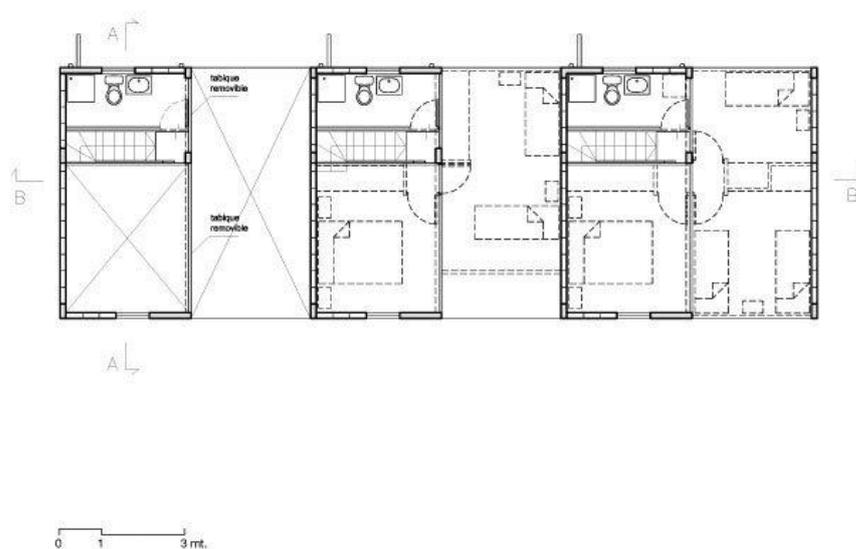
, 24 e 25 – Quinta Monroy – Elemental – Iquique – Chile. Plantas que ilustram o projeto e sugerem possíveis arrajos espaciais - Fonte: Archdaily
